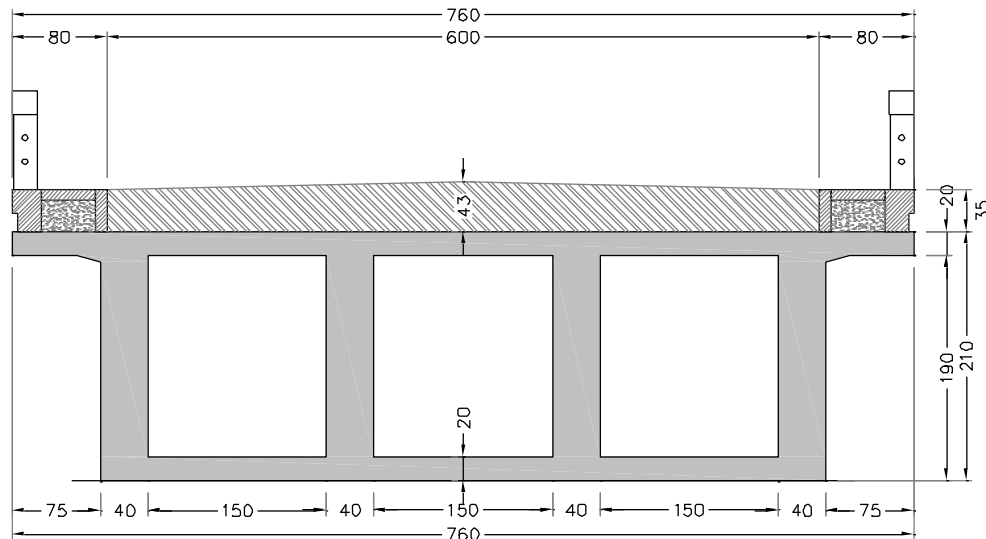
Sezione trasversale dell'impalcato sulle pile
